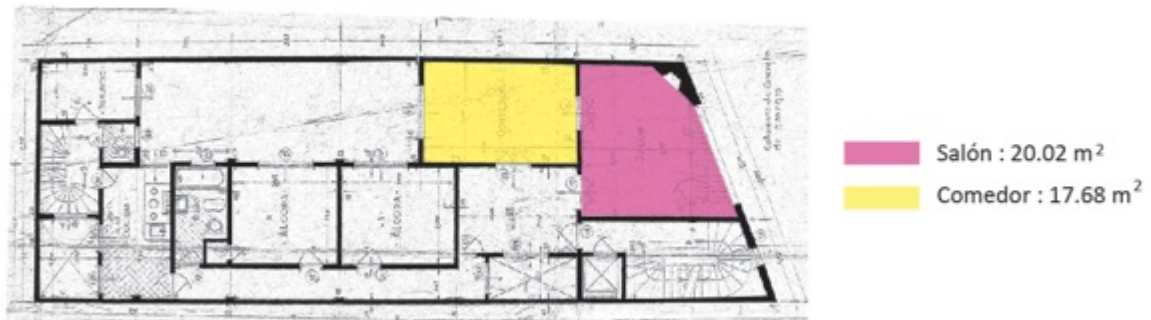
Planta Edificio para Reinaldo Melo – Trujillo, Gómez y Martínez Cárdenas. 1937.
